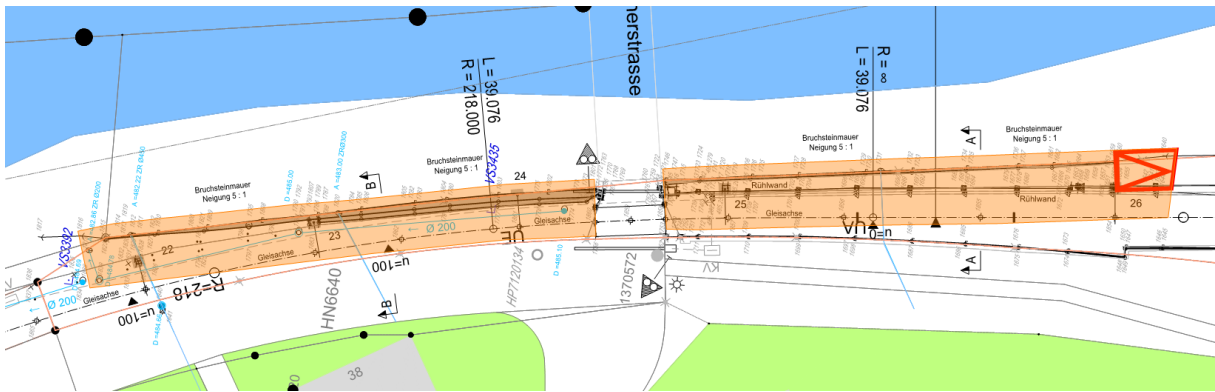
Baustelle - Erstellung ab Baugrubensohle
